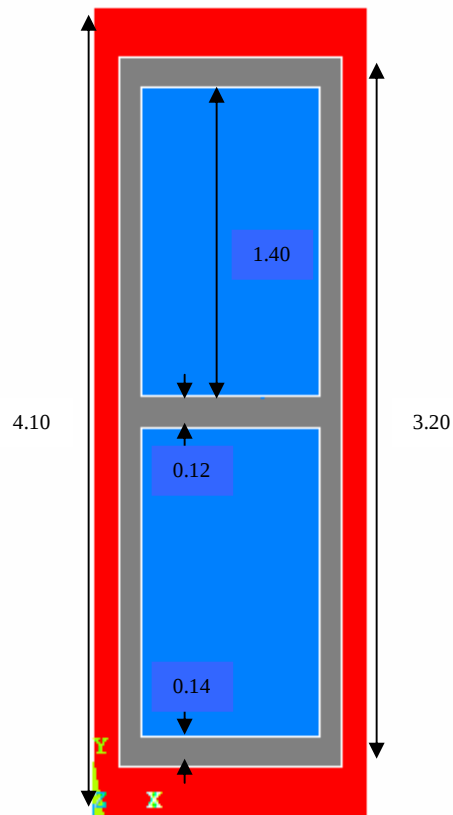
Vista de planta de una fosa del horno, medidas en metros.
